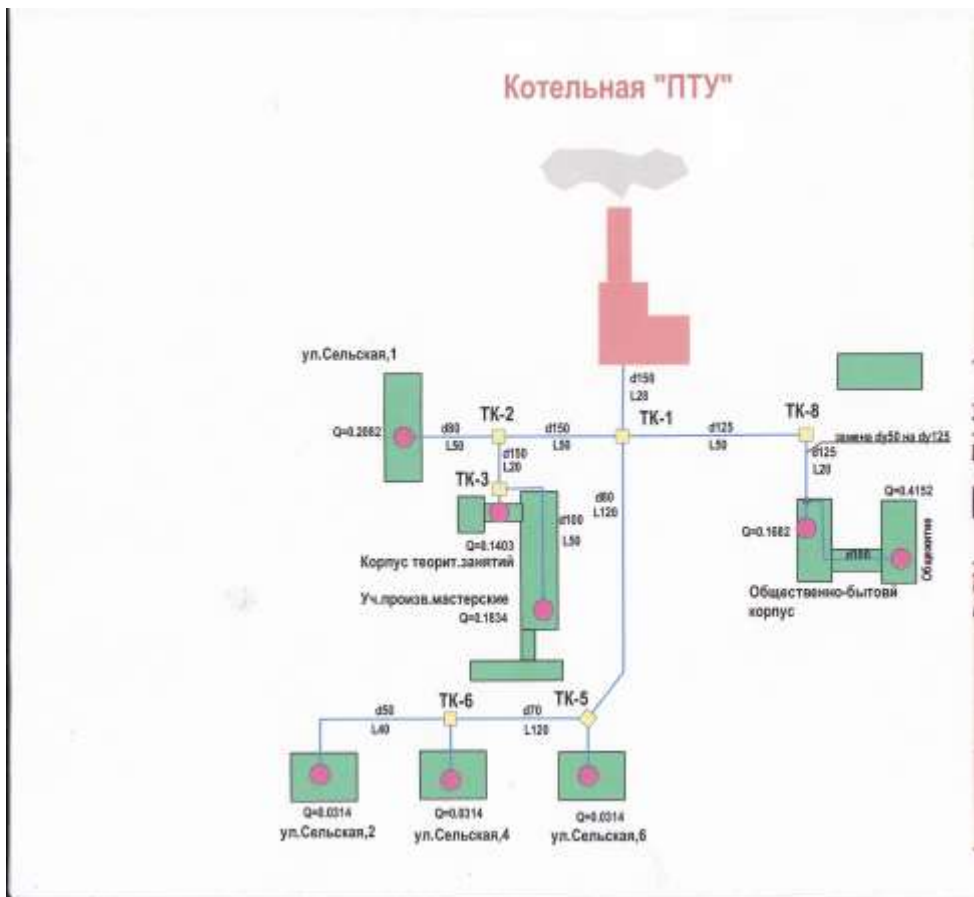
Схема зоны теплоснабжения от котельной ПТУ
